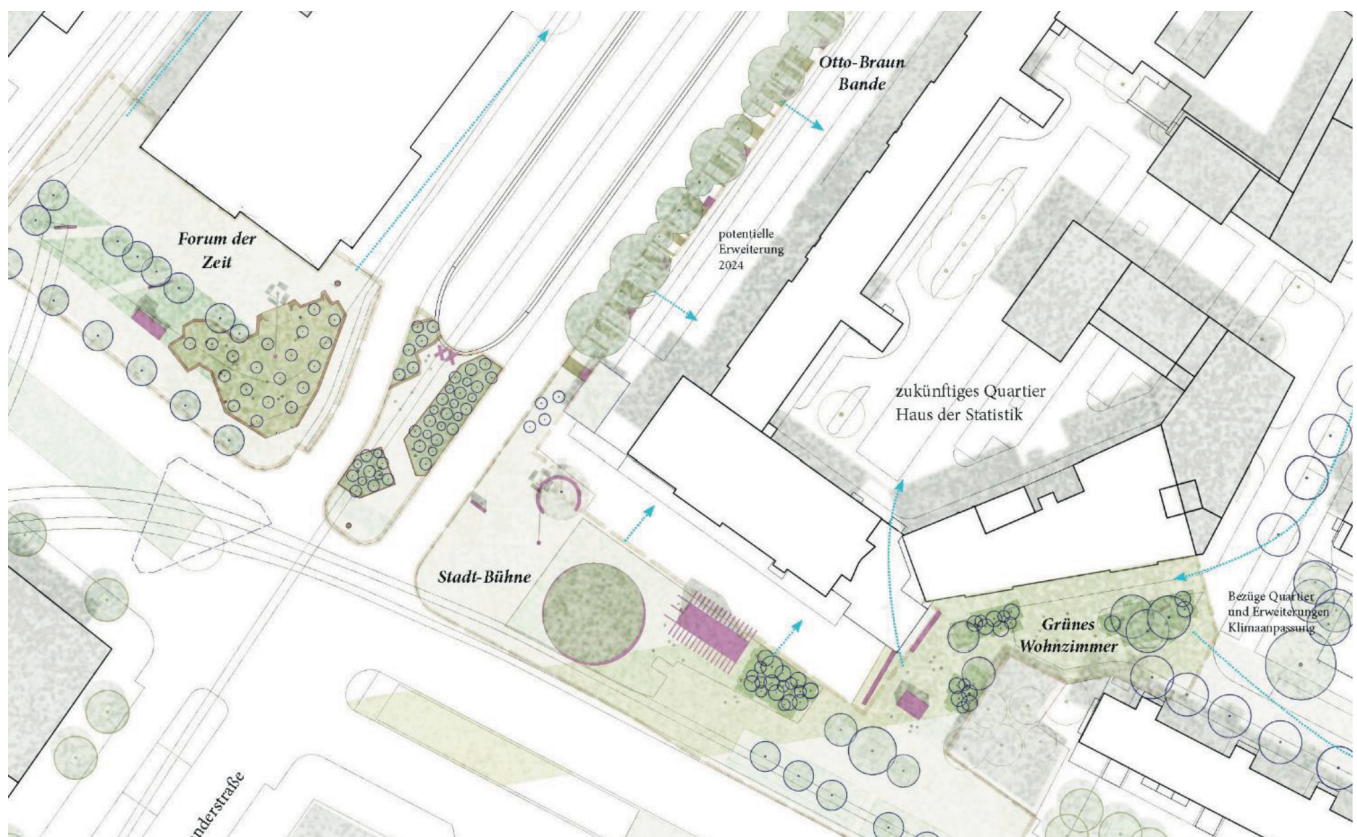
Plananschnitt Lageplan Team Robin Winogron, Studio Erde, Violeta Burckhardt und BeL Sozietät für Architektur
